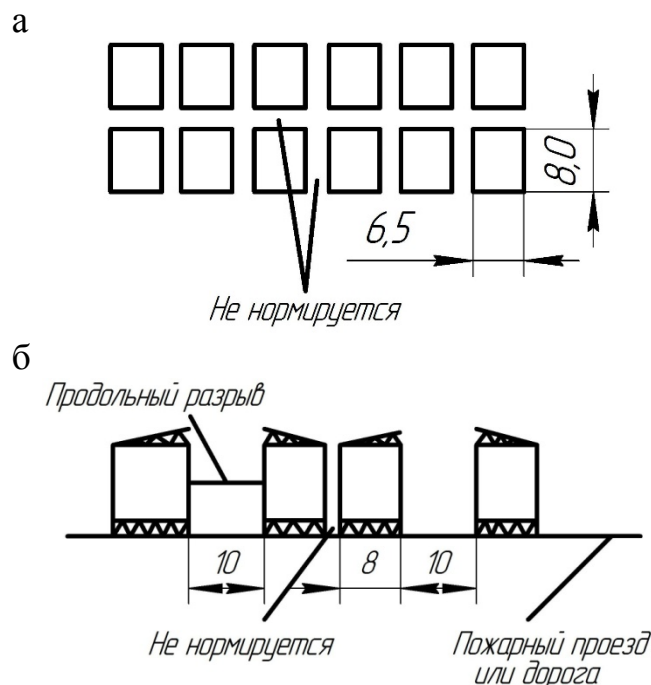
Схема штабелей пиломатериалов при открытом хранении:
